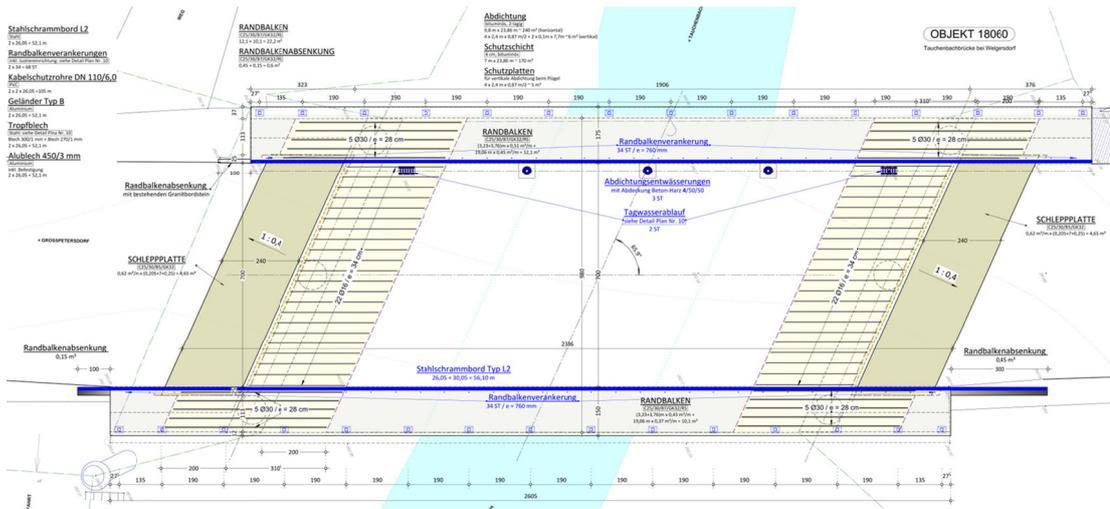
Grundriss Objekt 18060 [51]
